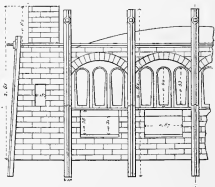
Vue latérale d'un four silésien à 24 moufles. — Échelle 0,0178.
